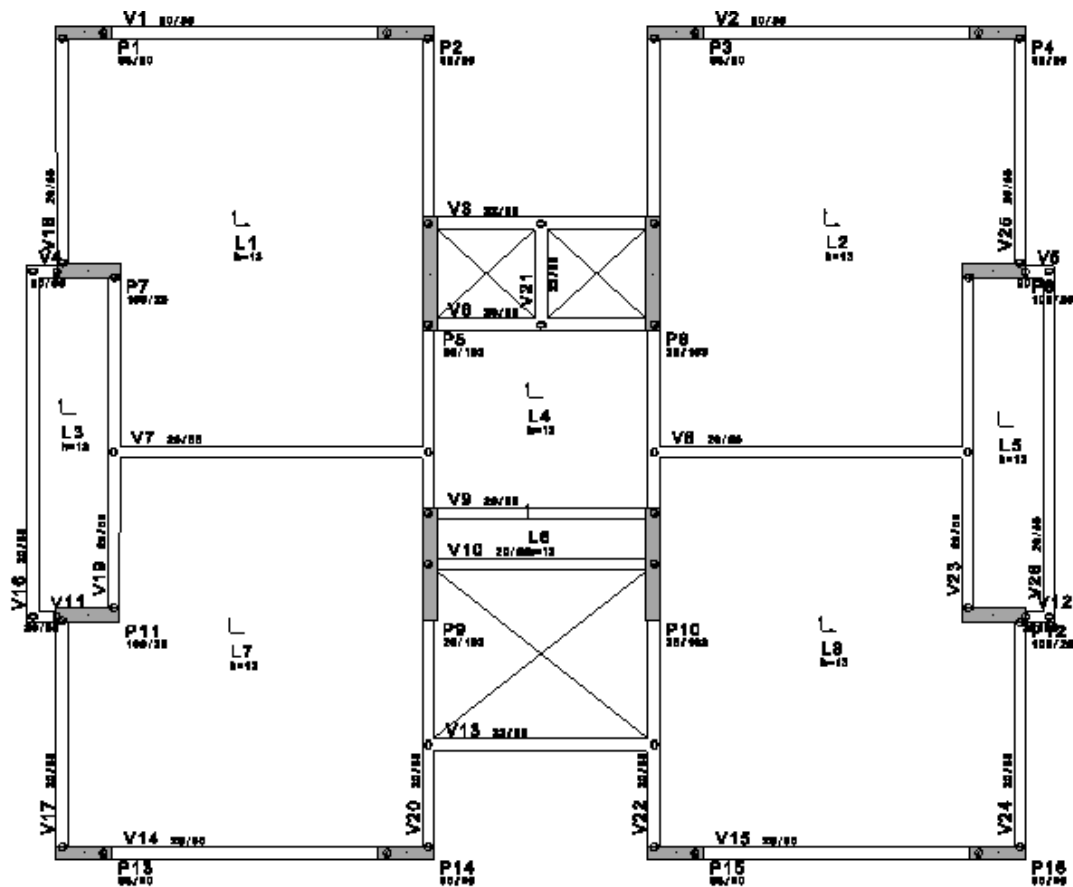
Planta baixa do pavimento tipo – Edifício Spazio Uno.
